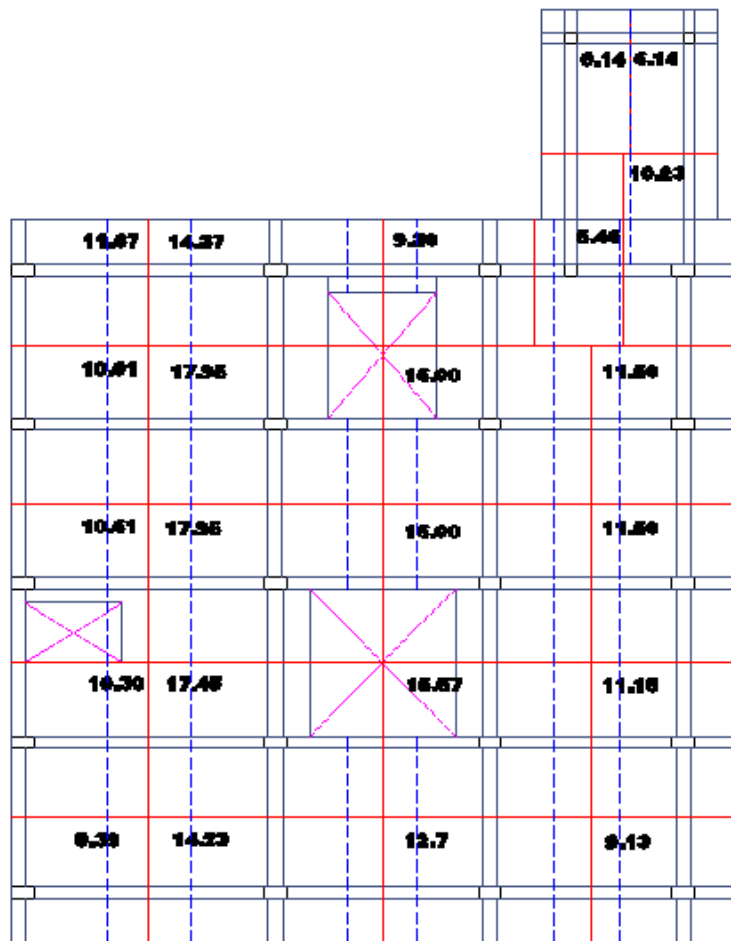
Ubicación en planta y área de tributaria de Columnas – Primer Piso
